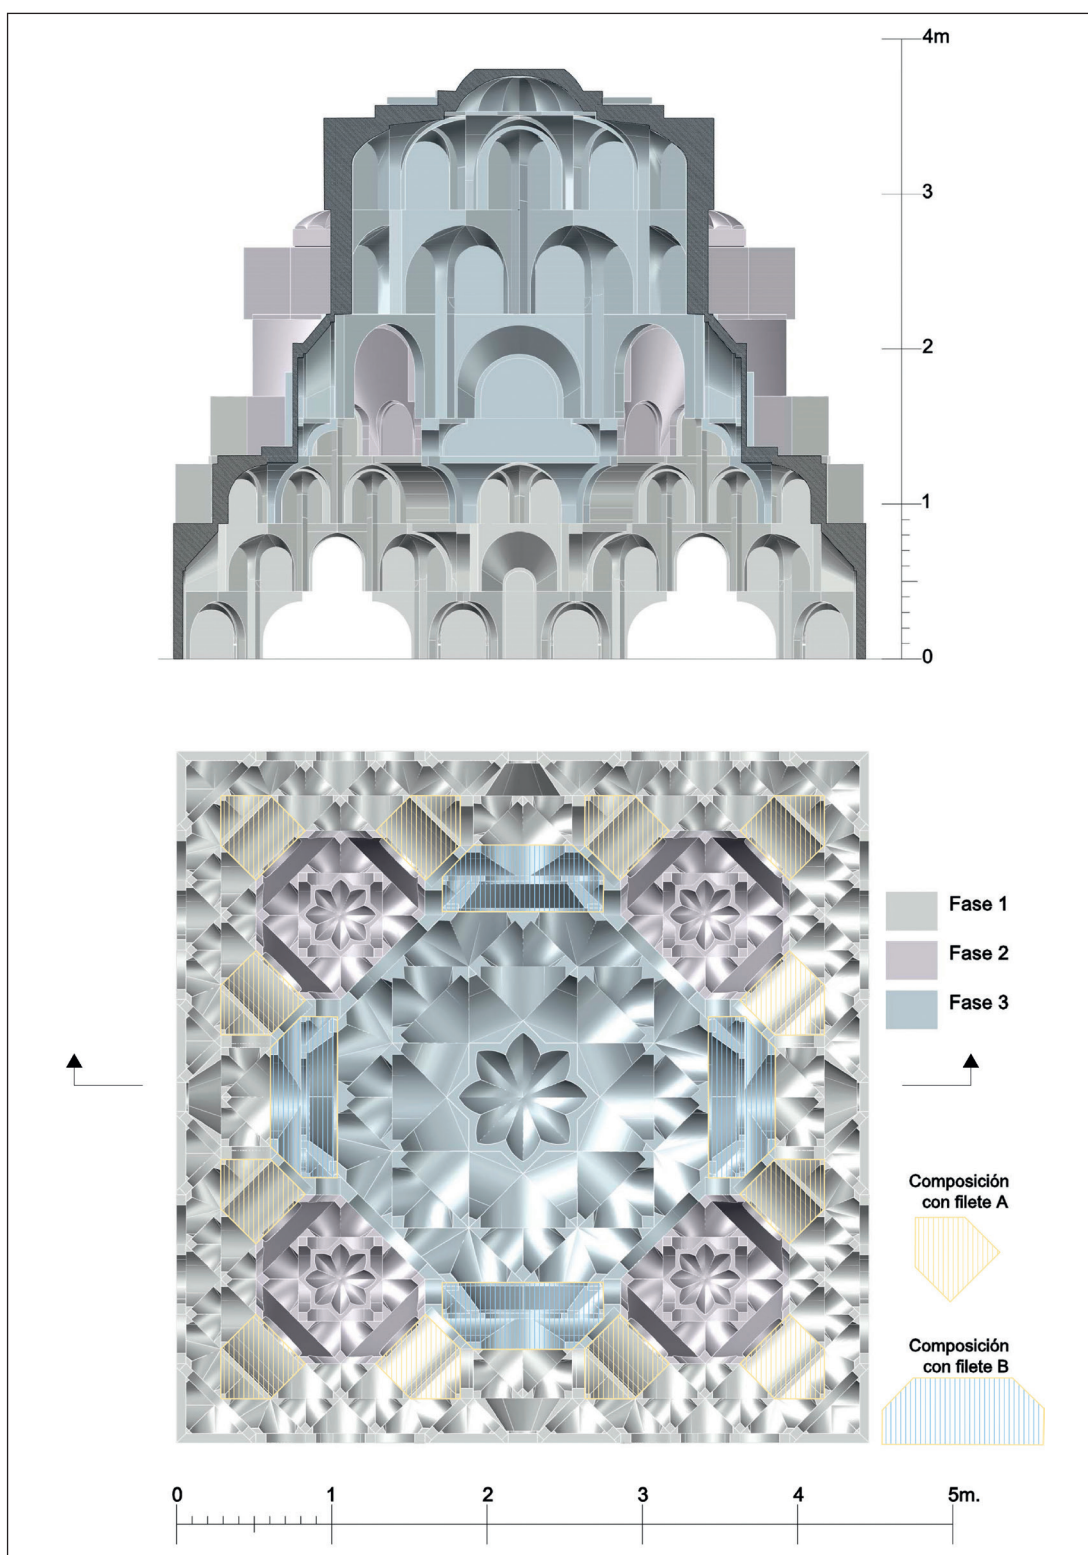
Planta y sección de la primera versión del modelo tridimensional elaborado para la bóveda T2.
